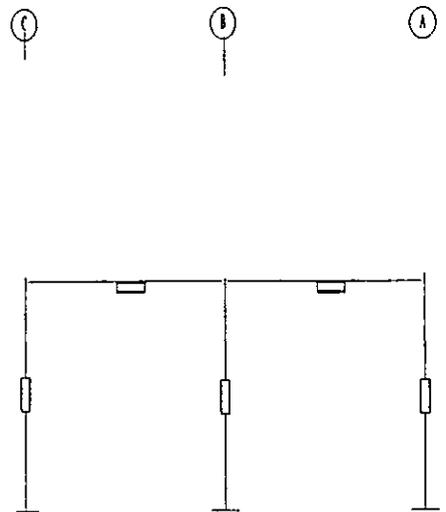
ELEVACIÓN MARCO EJE "B"
